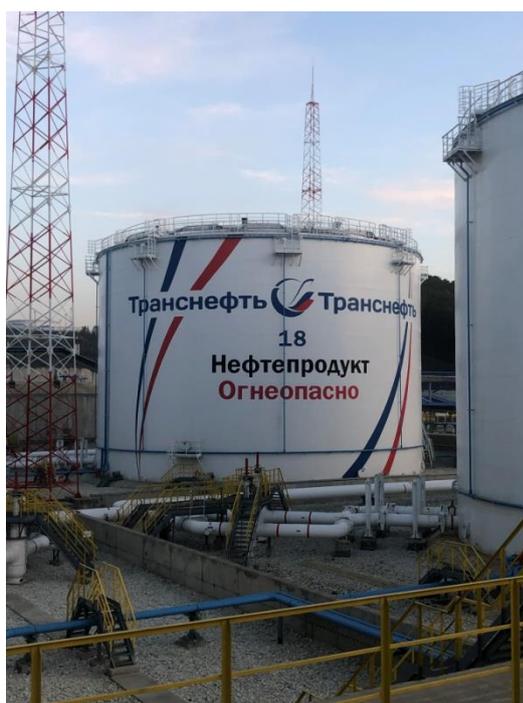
Общий вид резервуара РВСП-20000 зав.№ 18
